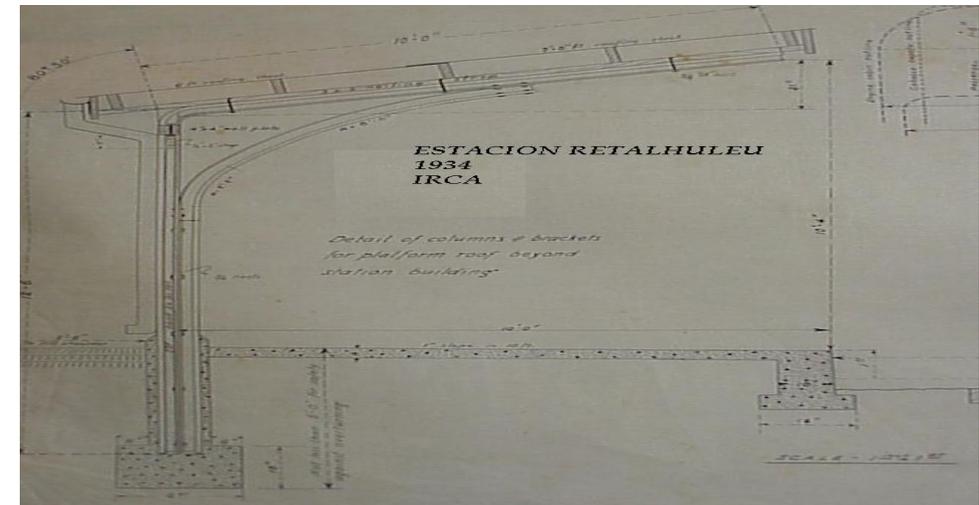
pertenece a los archivos de la Planoteca de FEGUA . oficina Central Guatemala.
